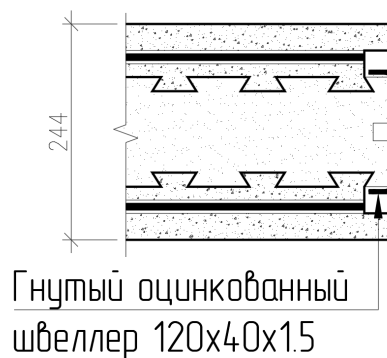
Сечение Г-Г. Горизонтальное армирование кладки нижних рядов в разрезе.
